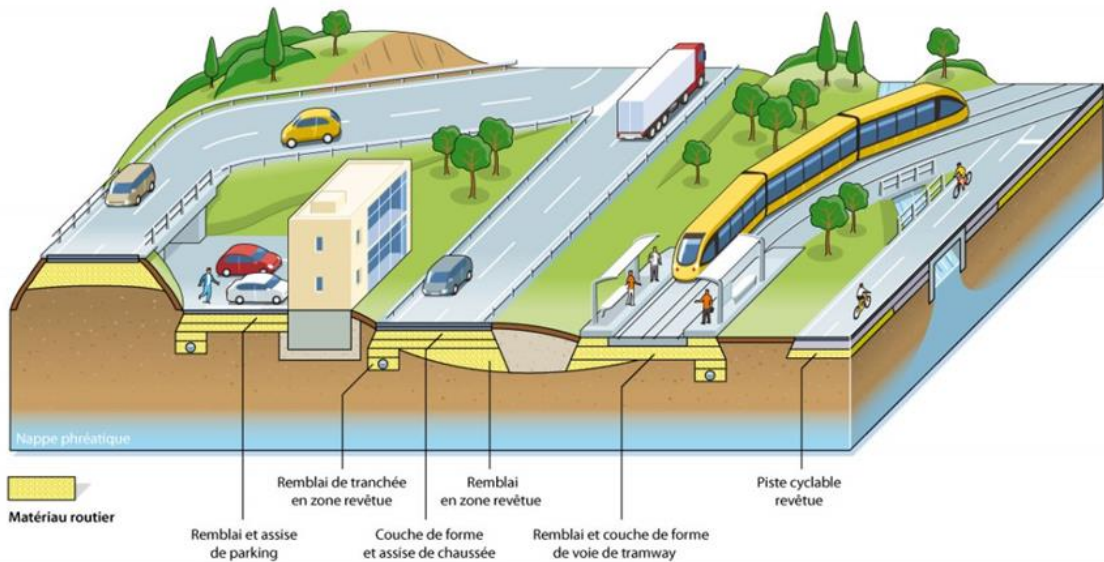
Usages routiers de type 1 (SETRA, 2011)
